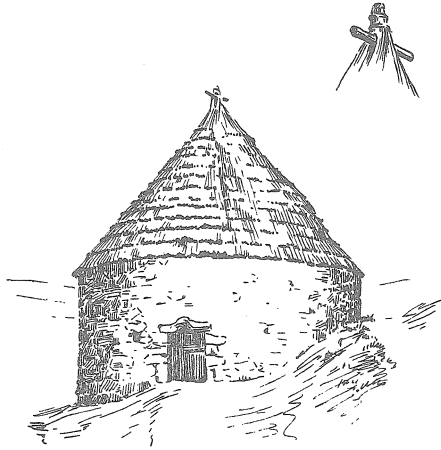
Palheiro de Barranco Velho (Loulé). Em cima vê-se um pormenor da construção da cobertura.
